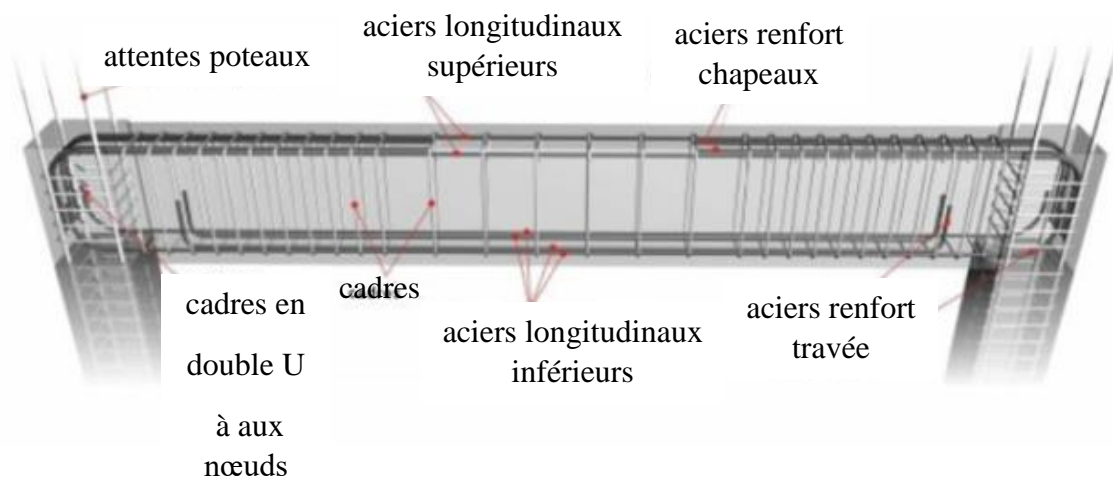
Disposition du ferrailage dans une poutre en béton armé [8]
